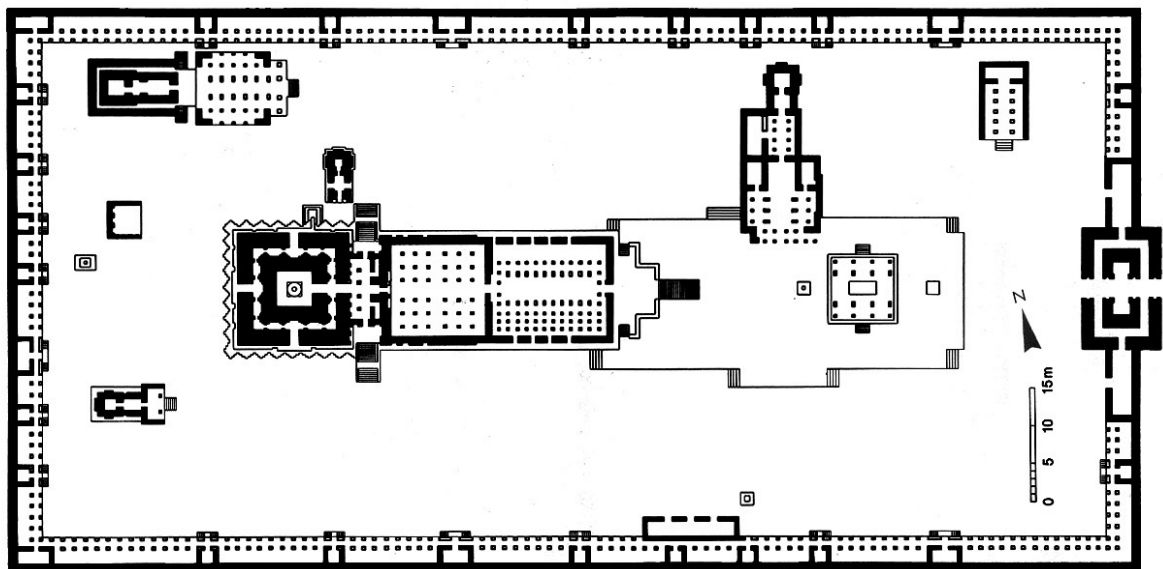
Grundriss Brhadēśvara-Tempel/Tañjavūr
